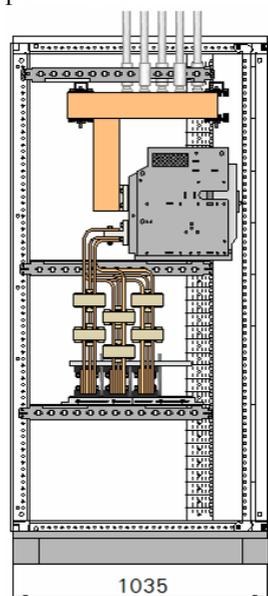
Внешний вид ГРЩ (вид сбоку)
